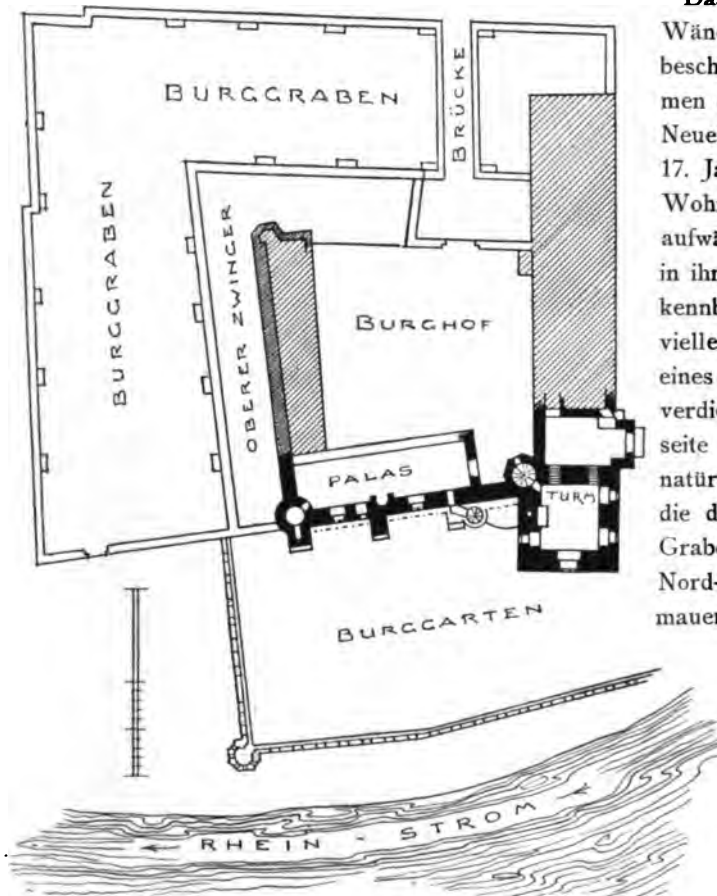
Eltvile. Grundriss der Burg.
